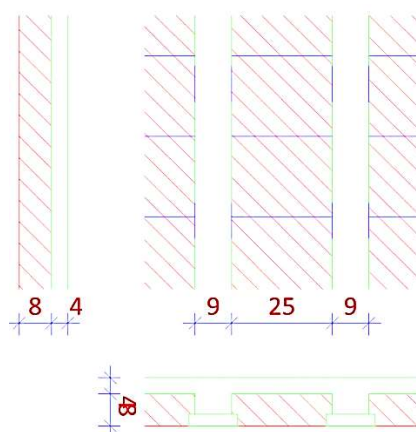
Detalhe da laje treliçada com lajota cerâmica na planta de forma.
